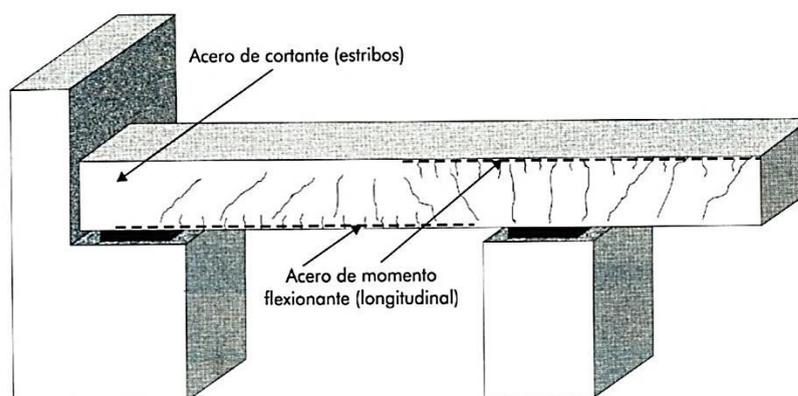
30 GRIETAS POR CORTANTE, FLEXIÓN Y TRACCIÓN A LO LARGO DE UNA VIGA SIMPLEMENTE APOYADA.
